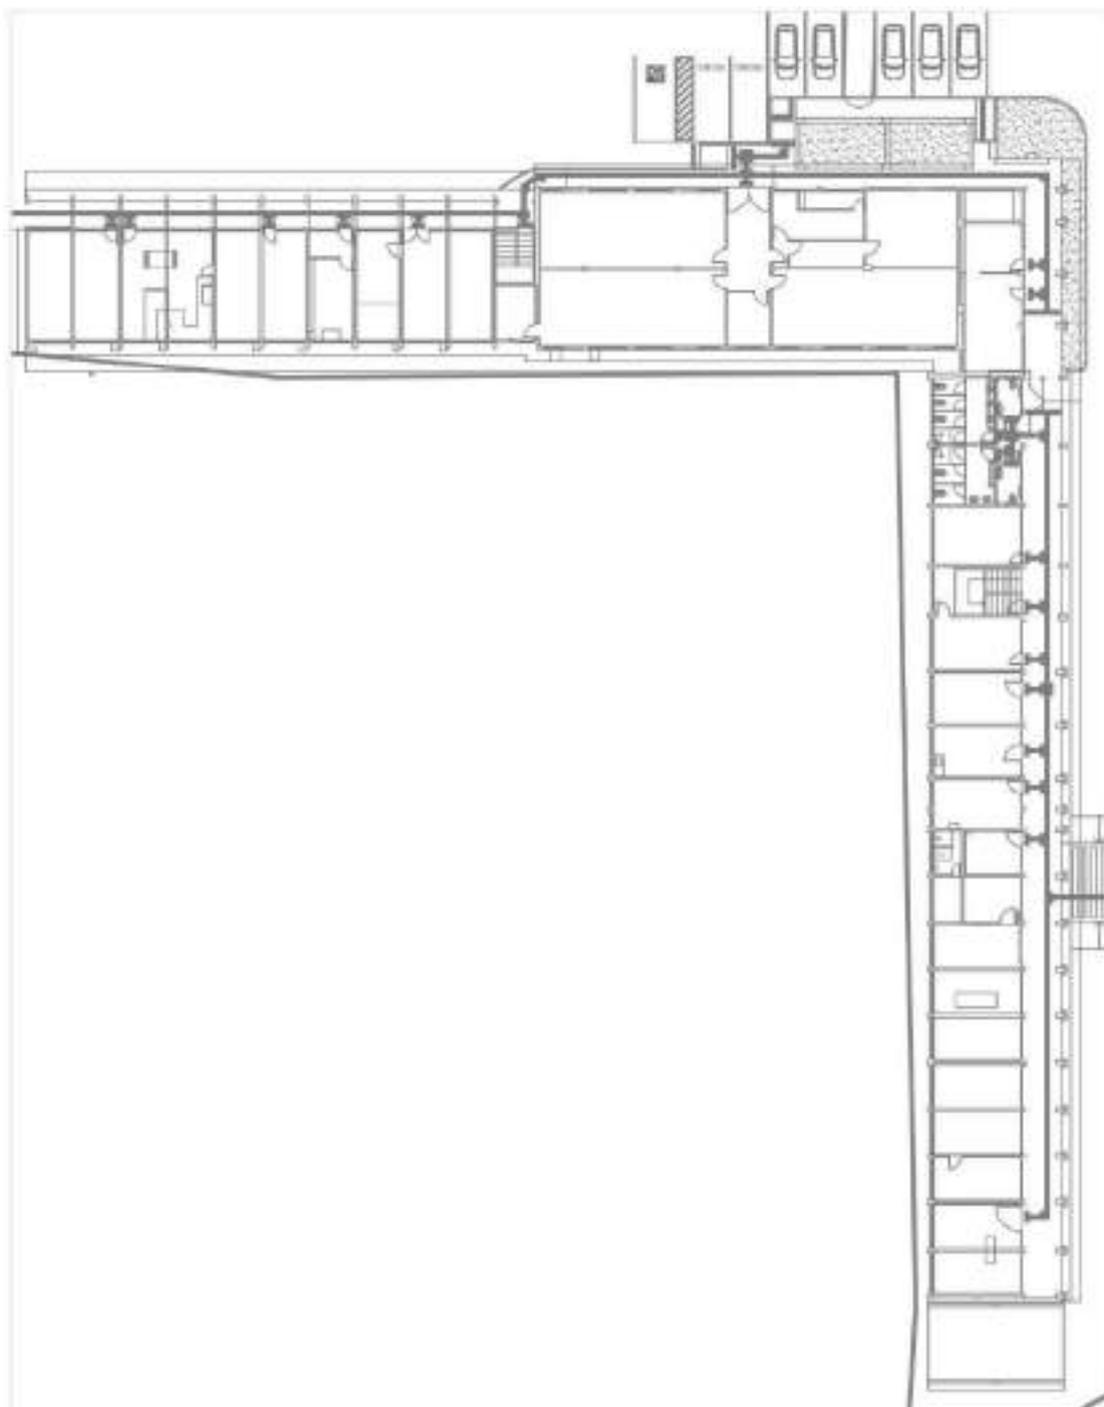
Planta baixa do térreo dos Laboratórios/Coordenações da UA1
